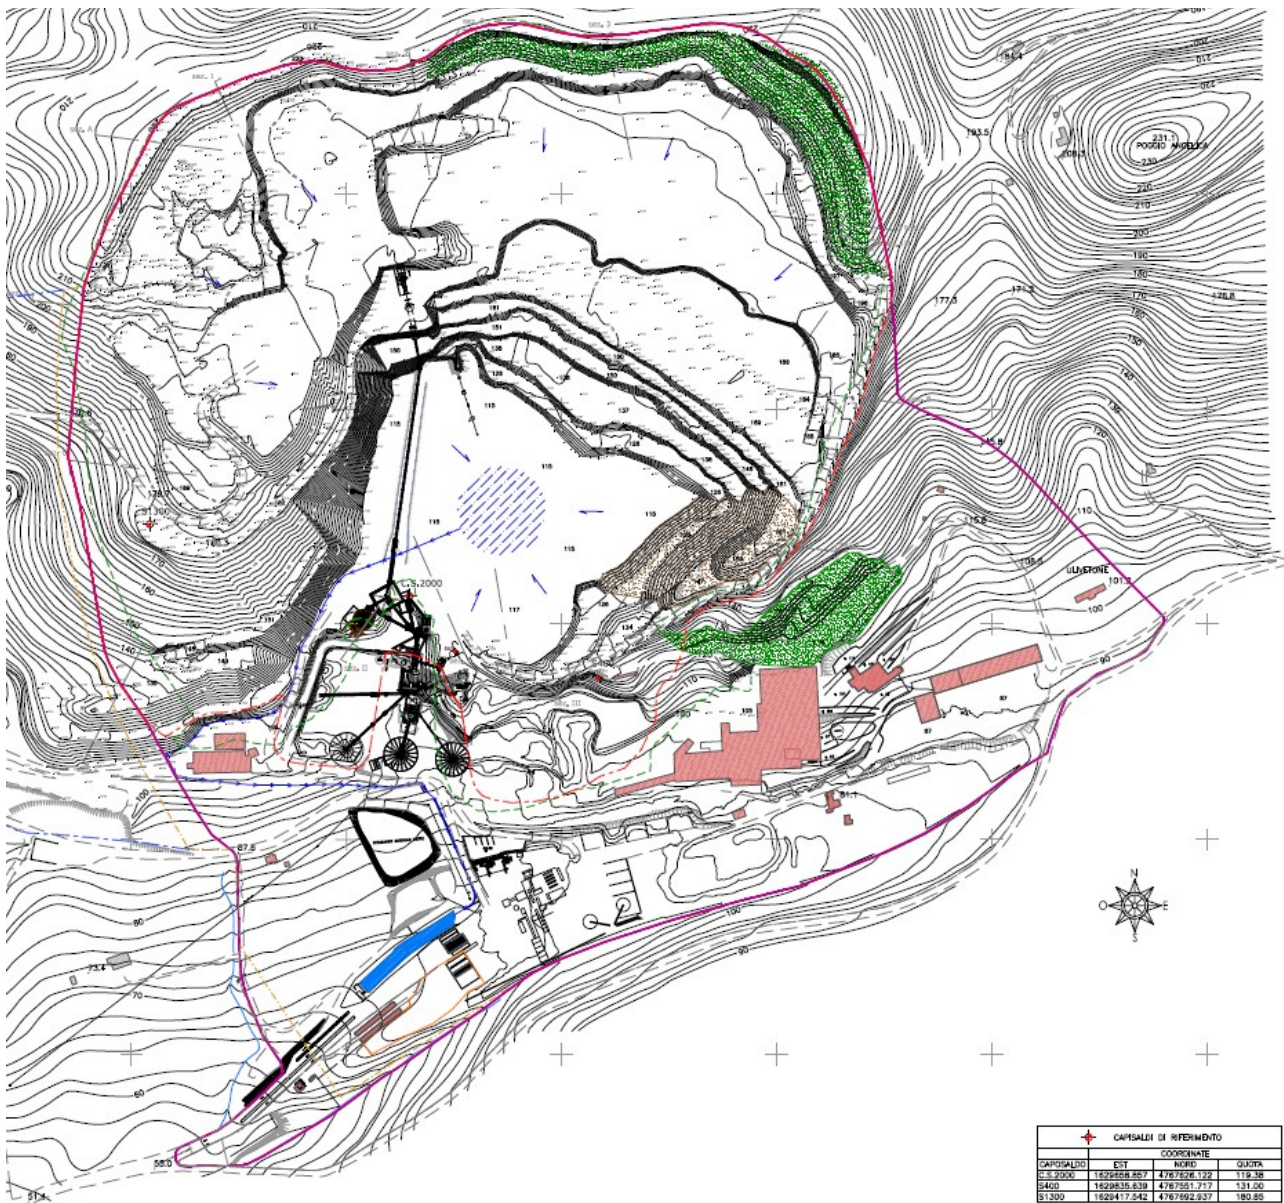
Stato attuale escavazione Monte Valerio - Variante all'autorizzazione vigente, per la quale ha avuto esito positivo il PAUR con DGRT 882/2021 ed è stata rilasciata autorizzazione comunale del progetto a breve termine con Atto unico suap/2022/28
